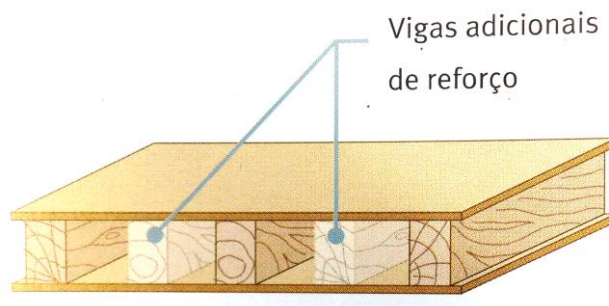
Reforço por adição de novas vigas paralelas às existentes [4]
